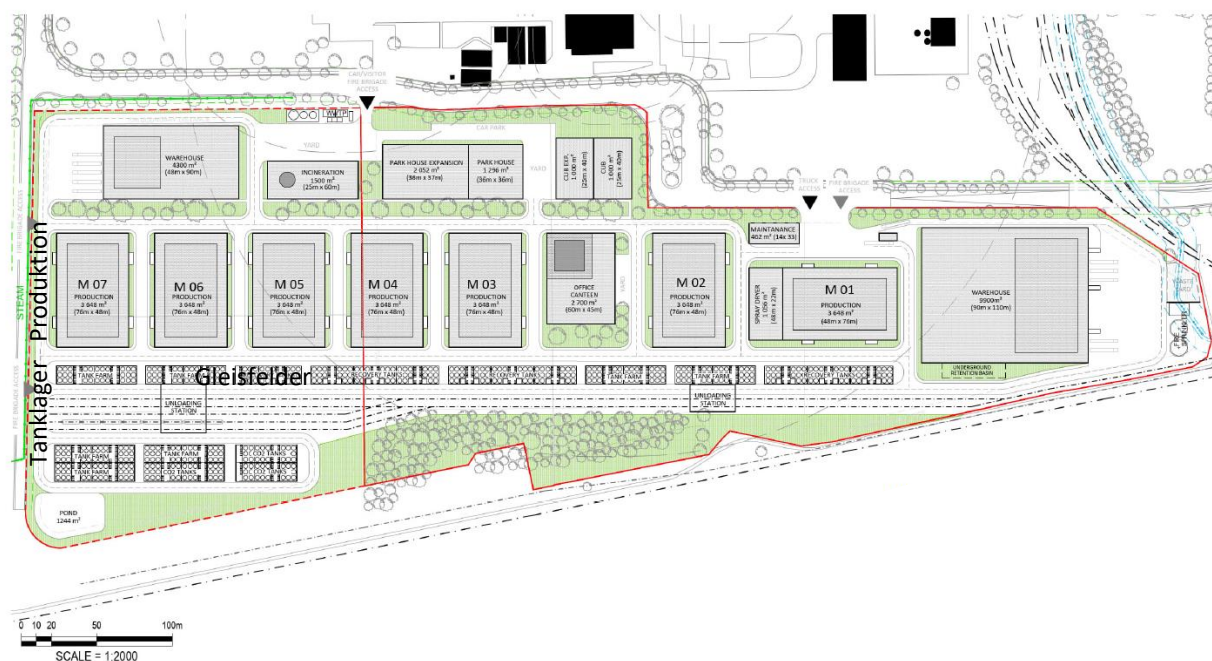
Planübersicht Site Masterplan, Quelle: Bachem, Stand 30.10.2024.
